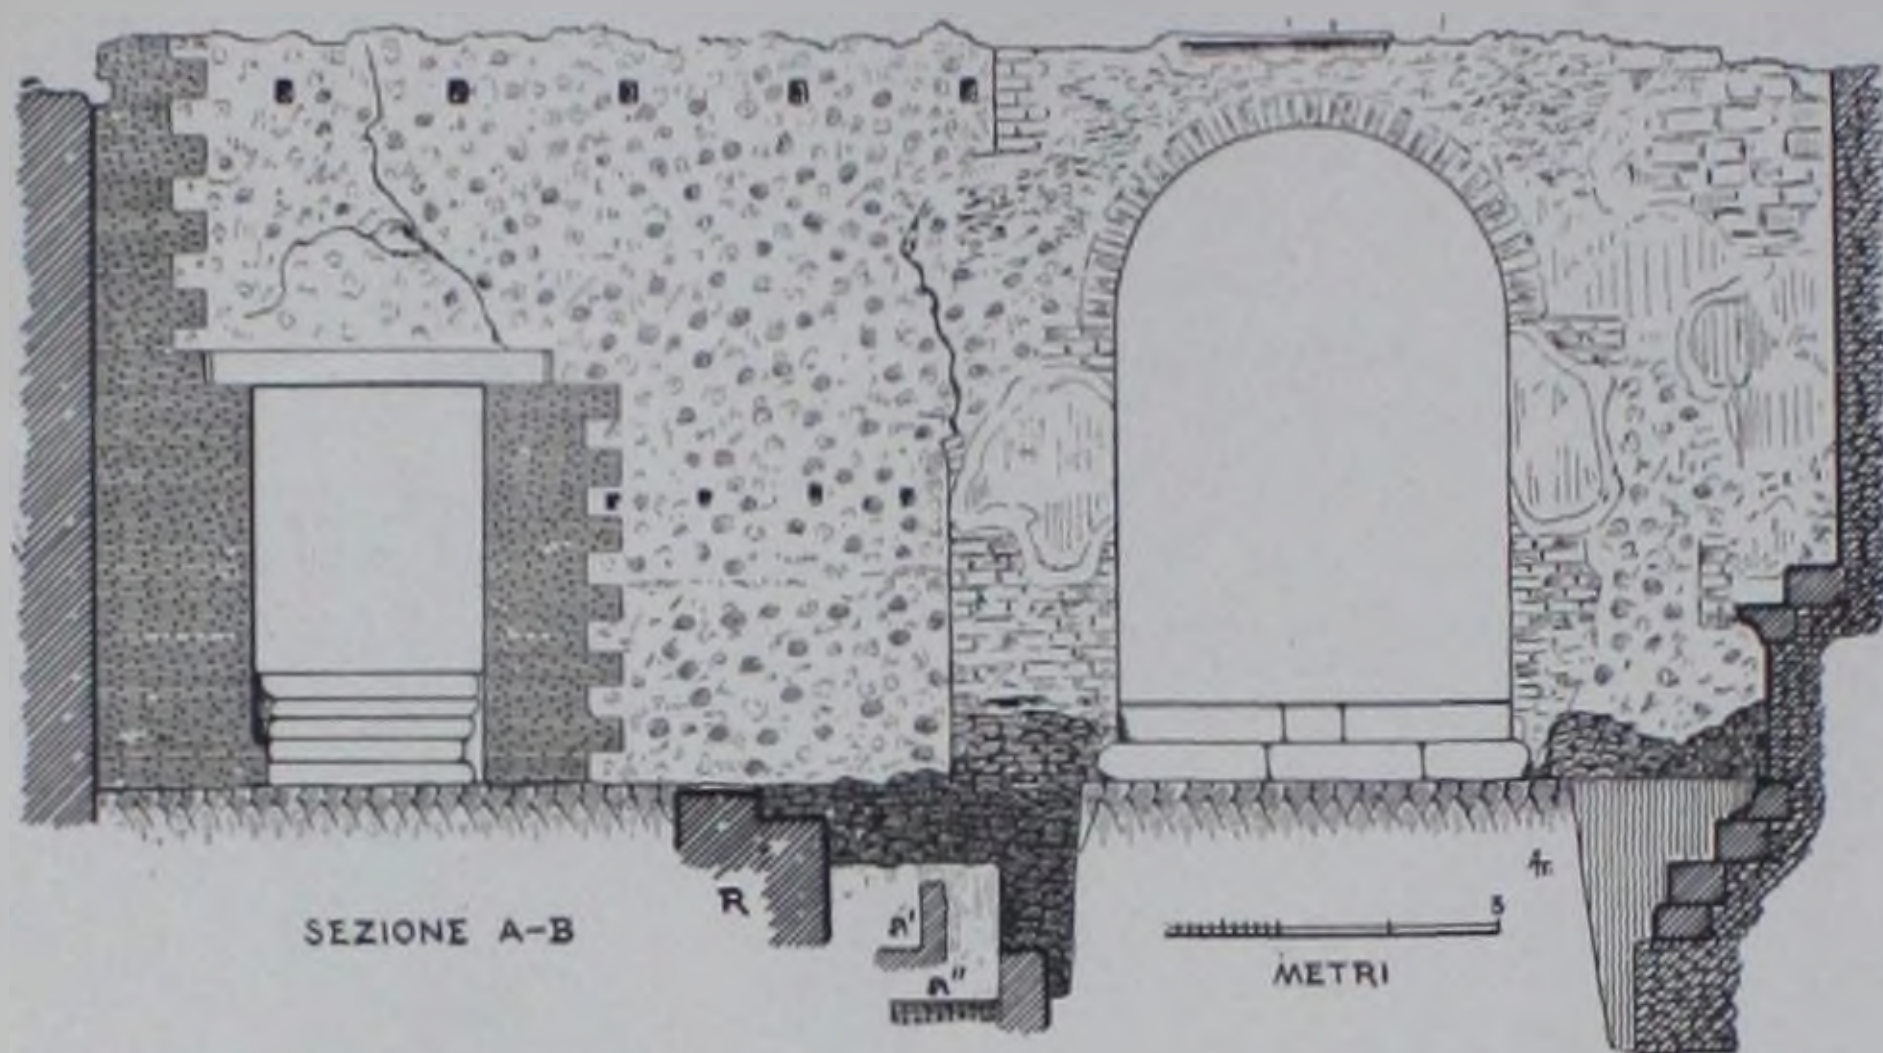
Muro divisorio posteriore del lato nord del Foro (fronte meridionale).
